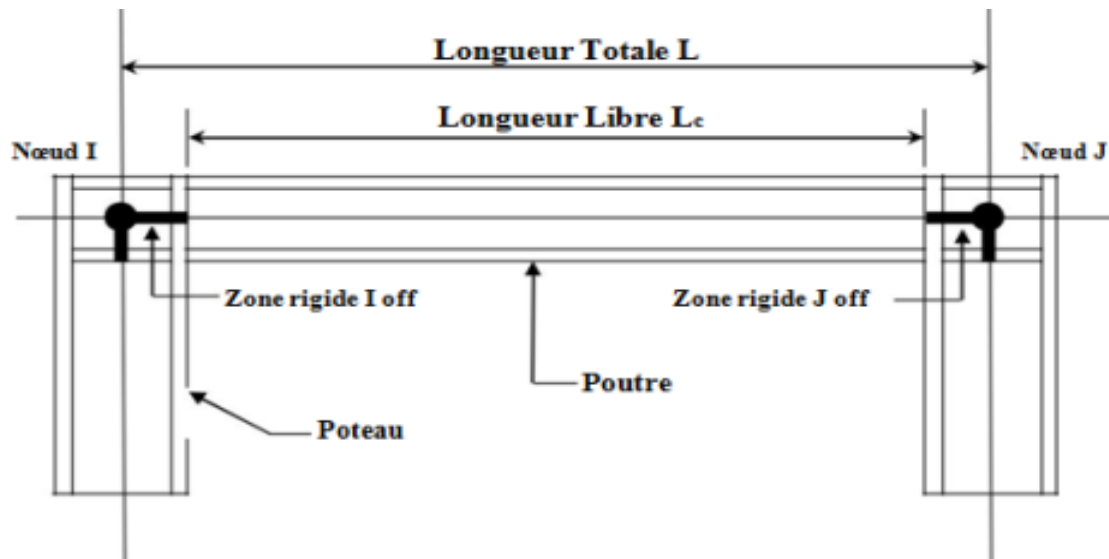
Attribution des Rigid end Offsets aux bouts des éléments poutres et poteaux.
